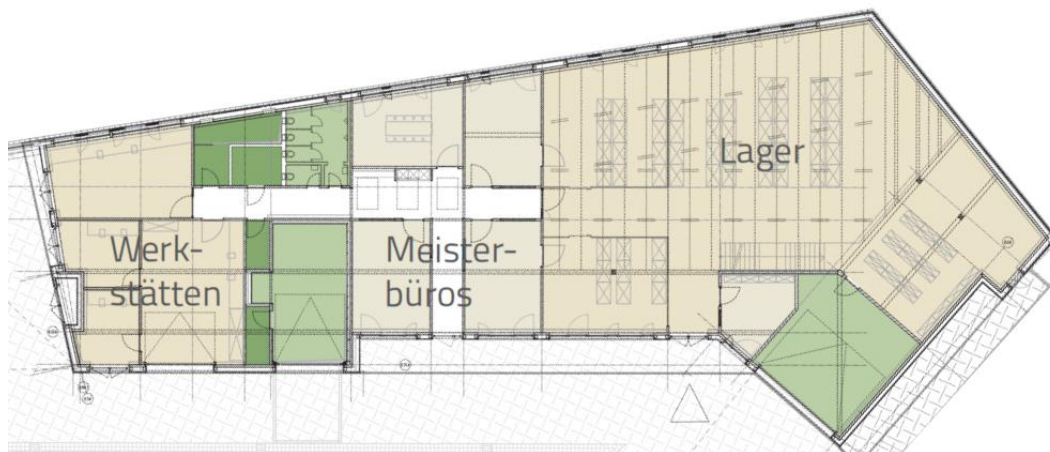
Grundriss Werkstatt- und Lagergebäude (Haus B)
